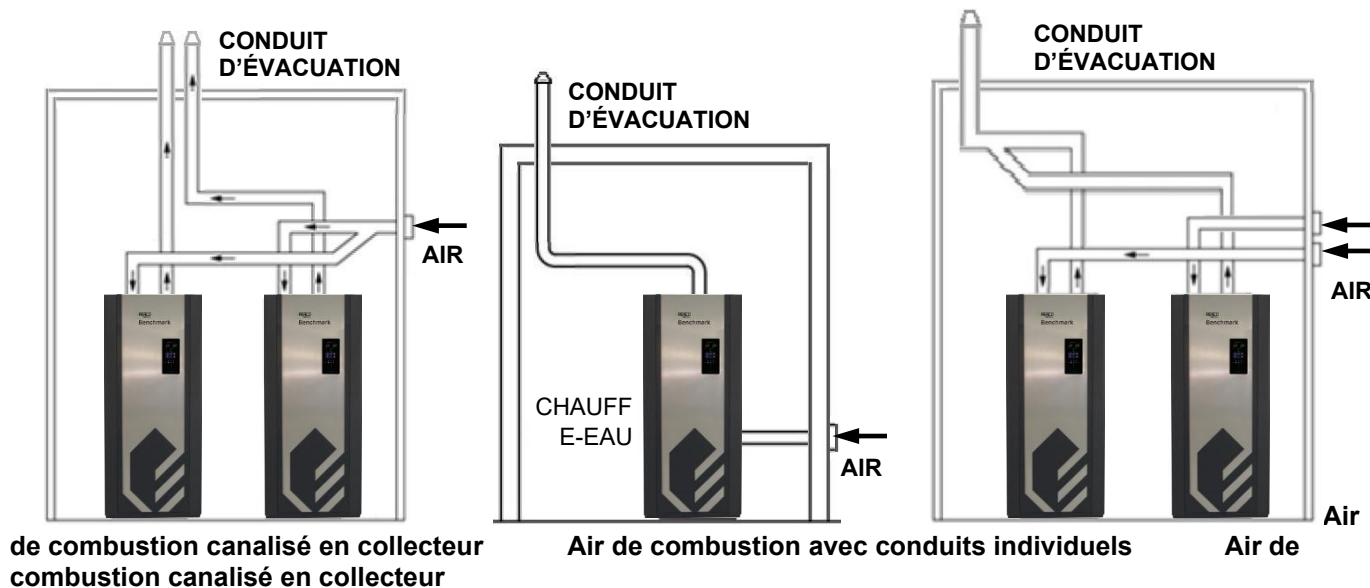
conduits d'évacuation individuels : installations ACCEPTABLES
